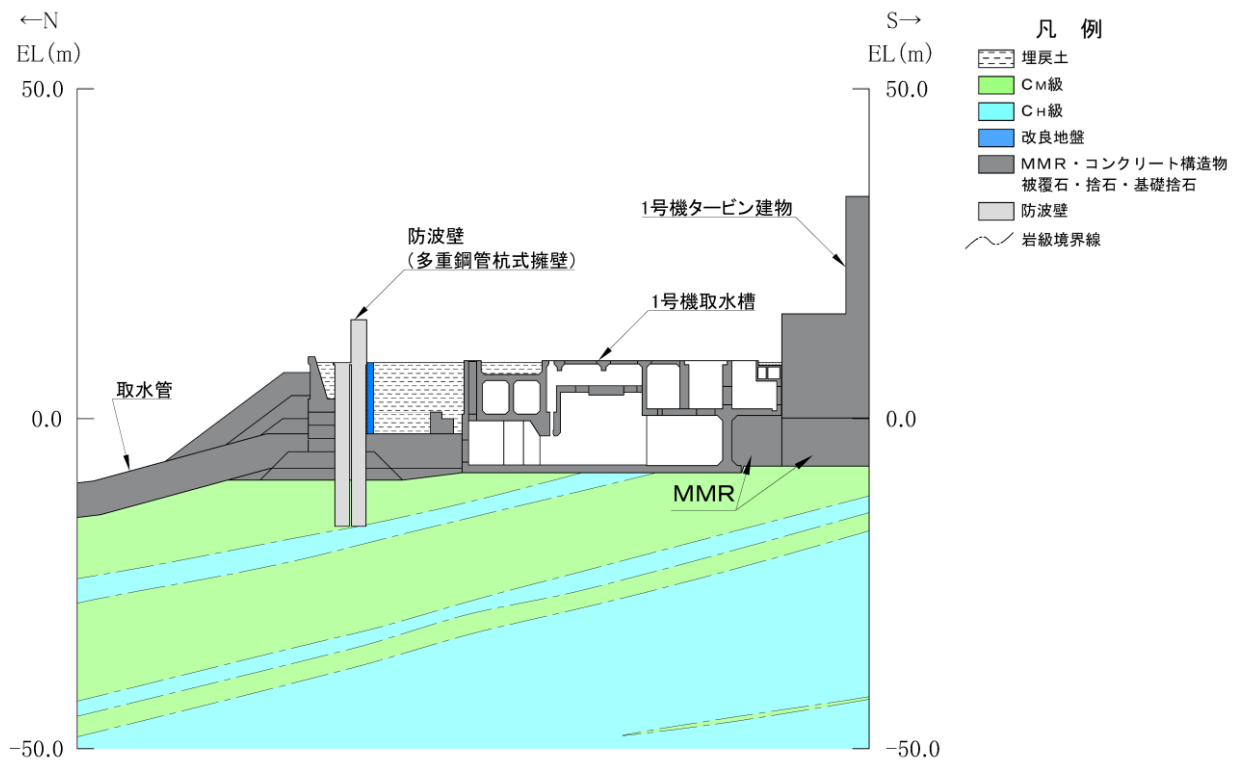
1号機取水槽 評価対象地質断面図 (A-A断面)
